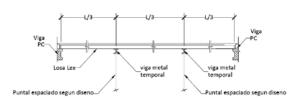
Detalle de apuntalamiento de Losa Lex
